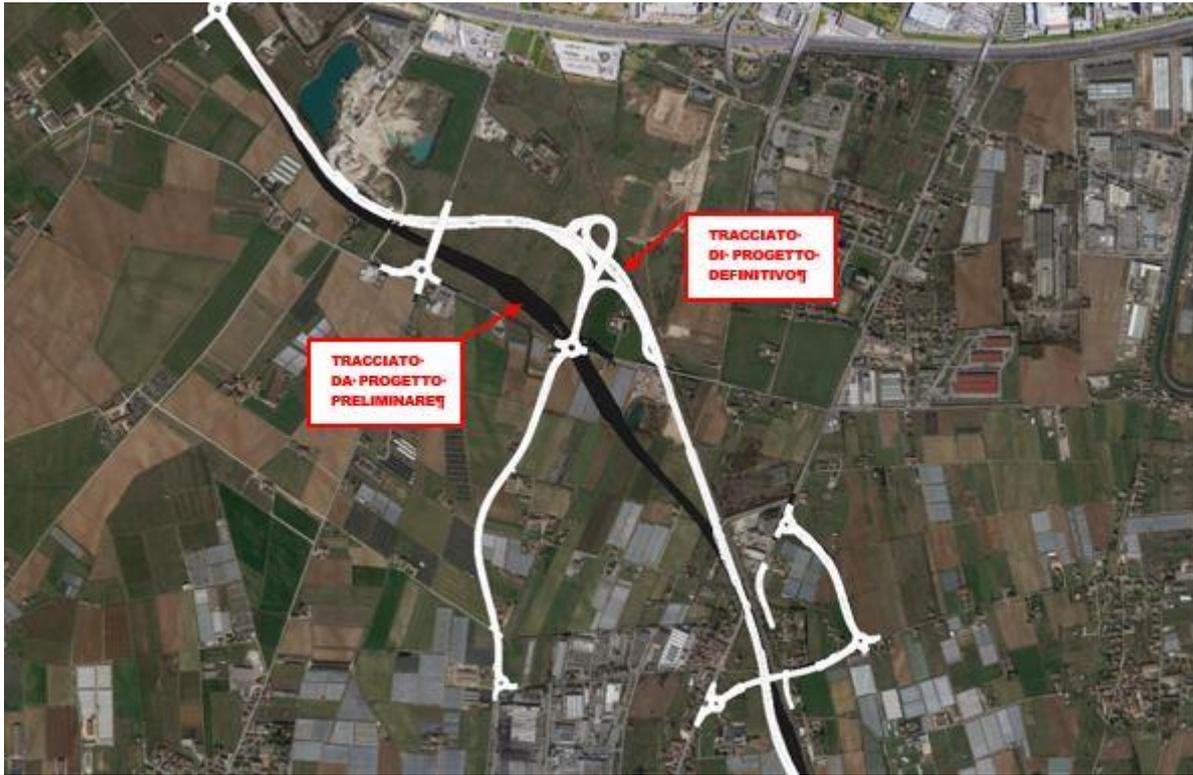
Stralcio planimetria di confronto progetto preliminare-progetto definitivo
